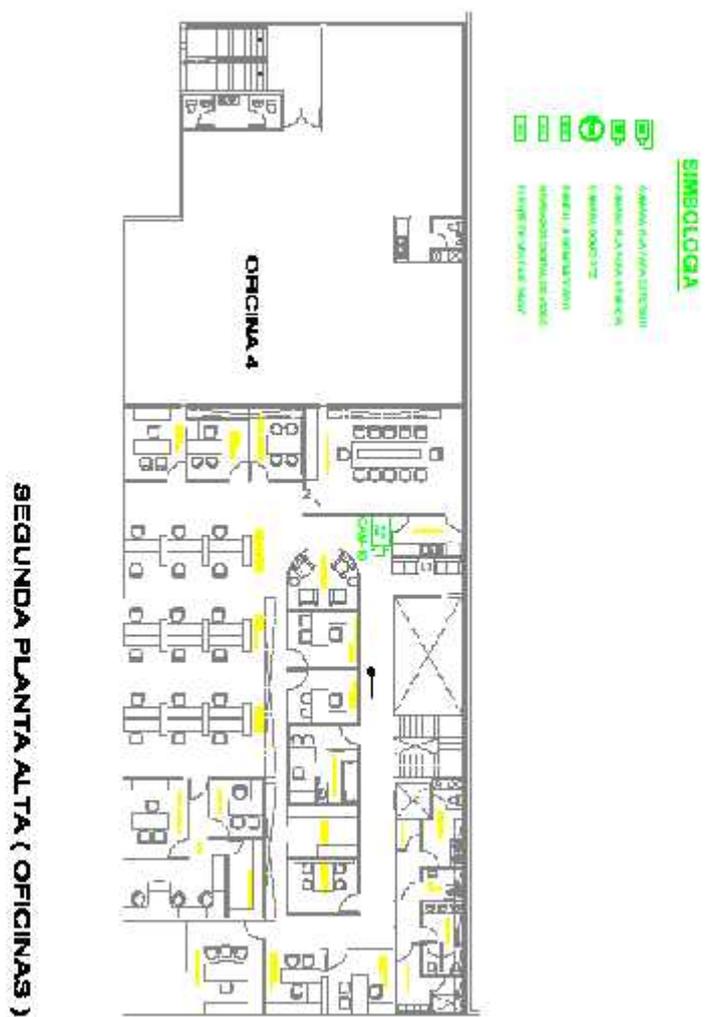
Cámaras CCTV en la segunda planta alta del área comercial
